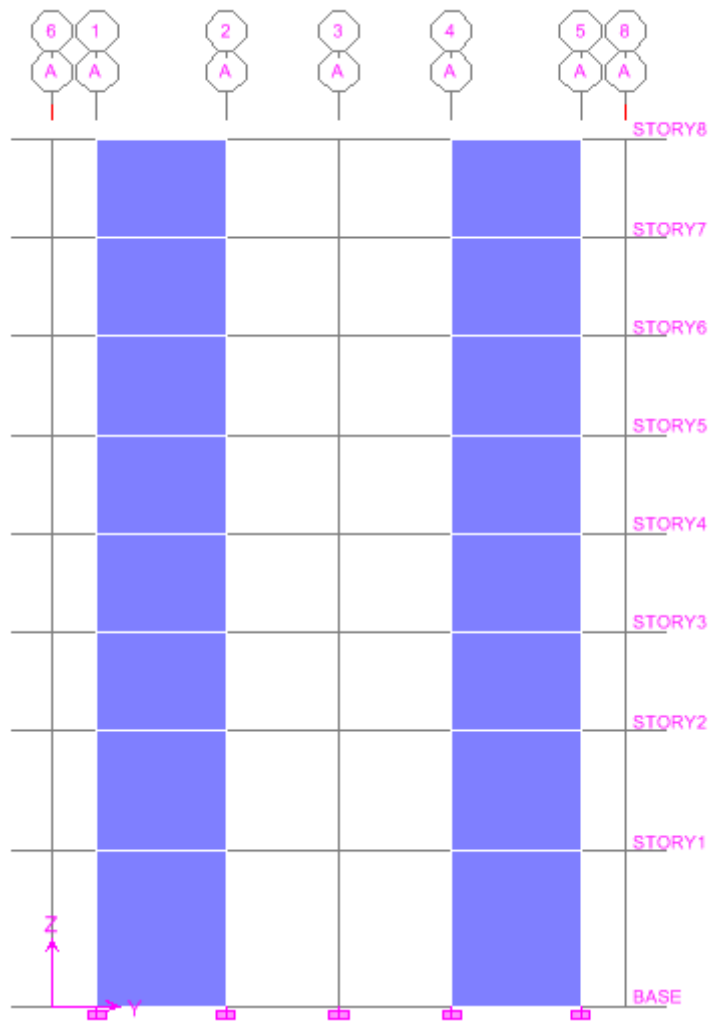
Vue en élévation des voiles pleins sens transversal
